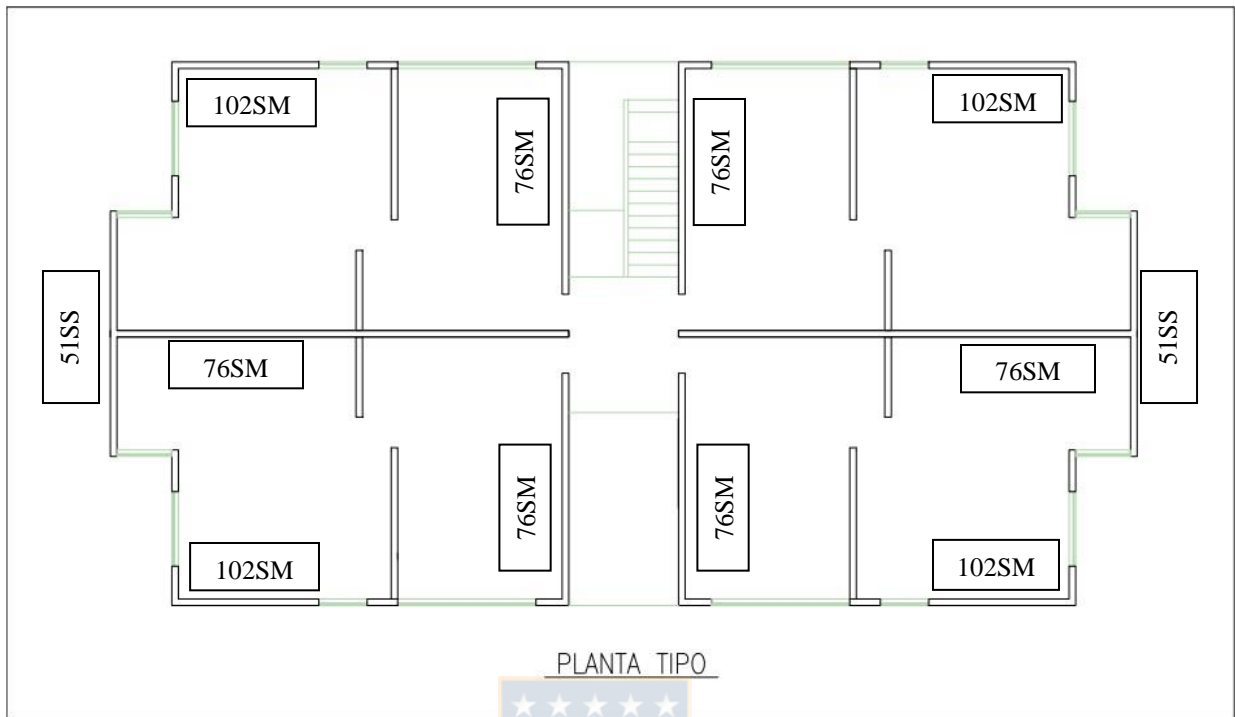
Vista en planta del primer piso modelo completo
